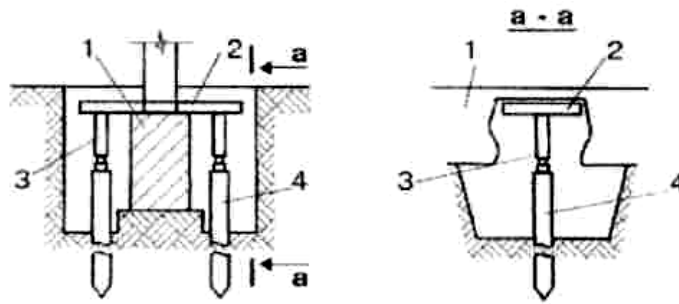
Схема підсилення фундаментів вдавленими палями:
